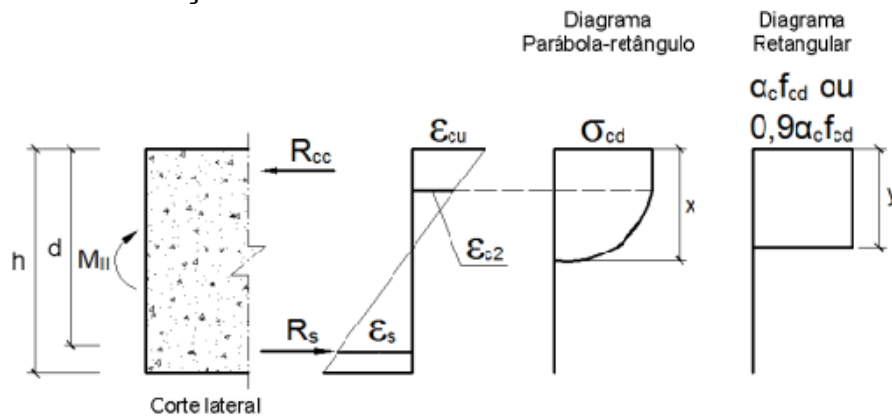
Seção de concreto armado fissurada no Estádio II.
